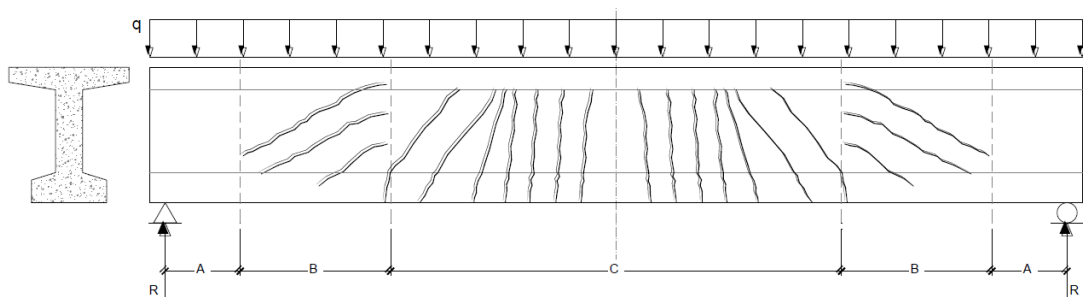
Zonas de agrietamiento en una viga presforzada
